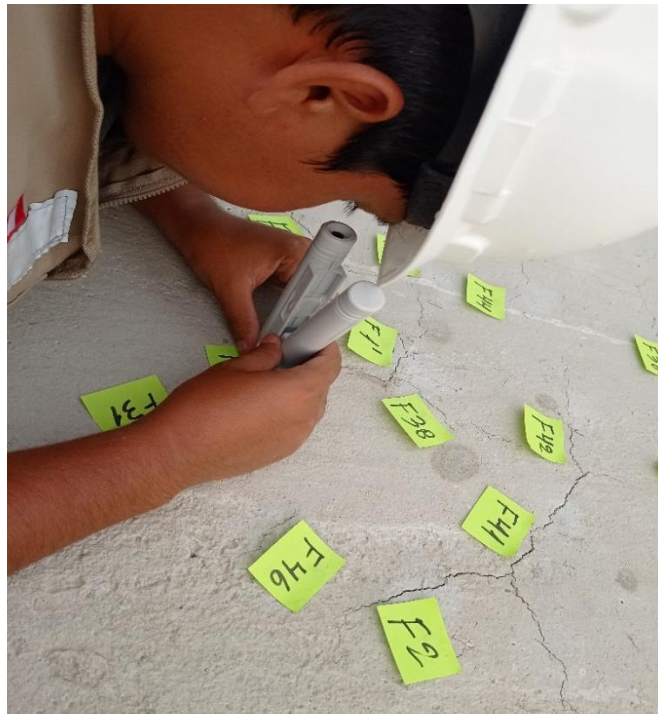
Losa aligerada patrón (Paño de prueba 1).
